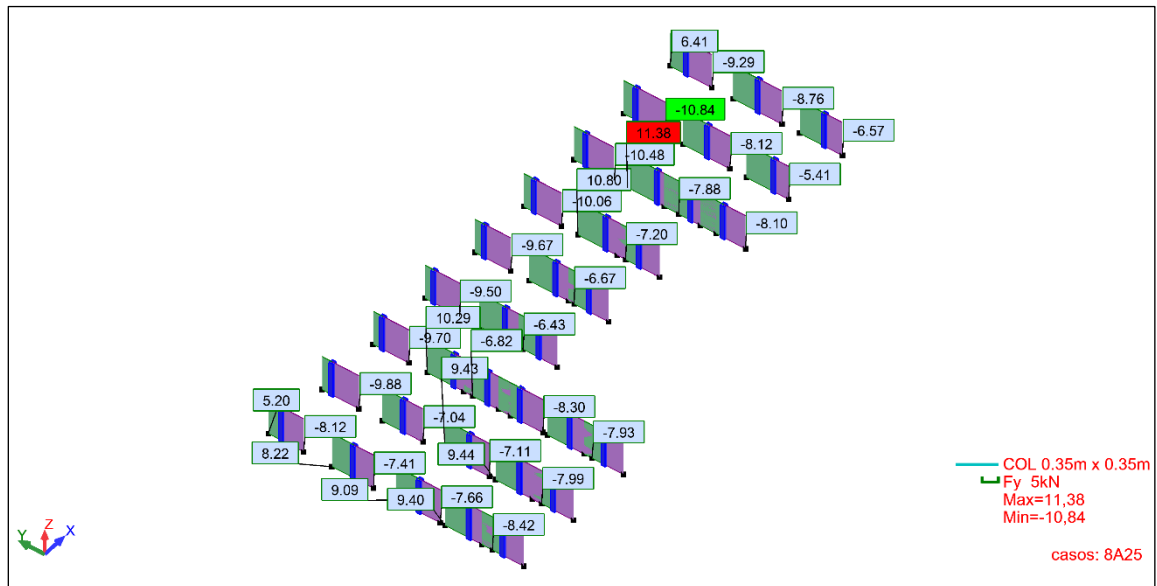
Cargas de cortante en dirección Y, para columnas.
